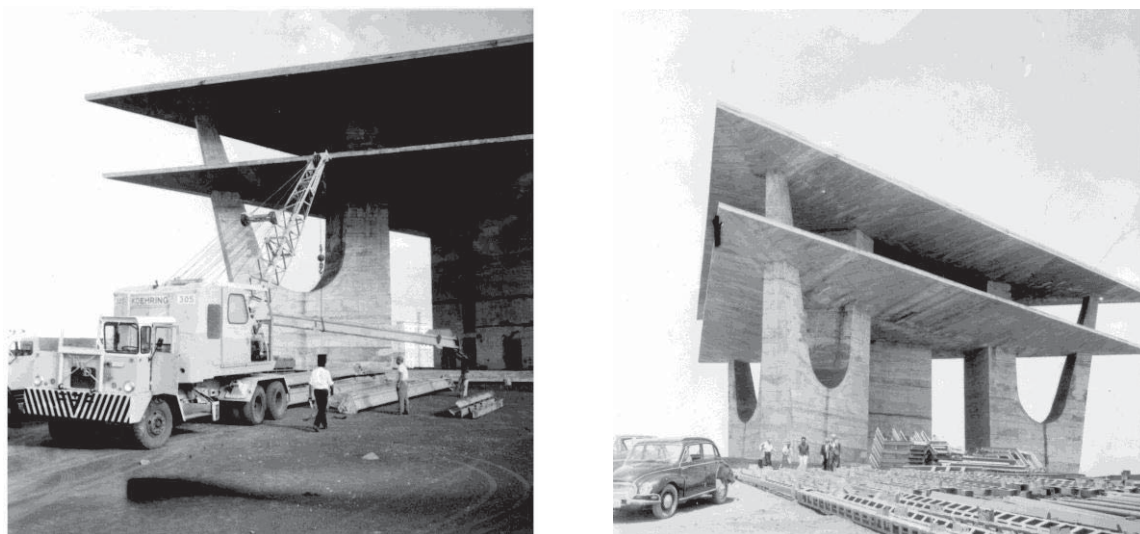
Estrutura de concreto armado da Torre (Fonte: ArPDF, Nº:1540 e 1543, Conteúdo: Construção da Torre de TV).
